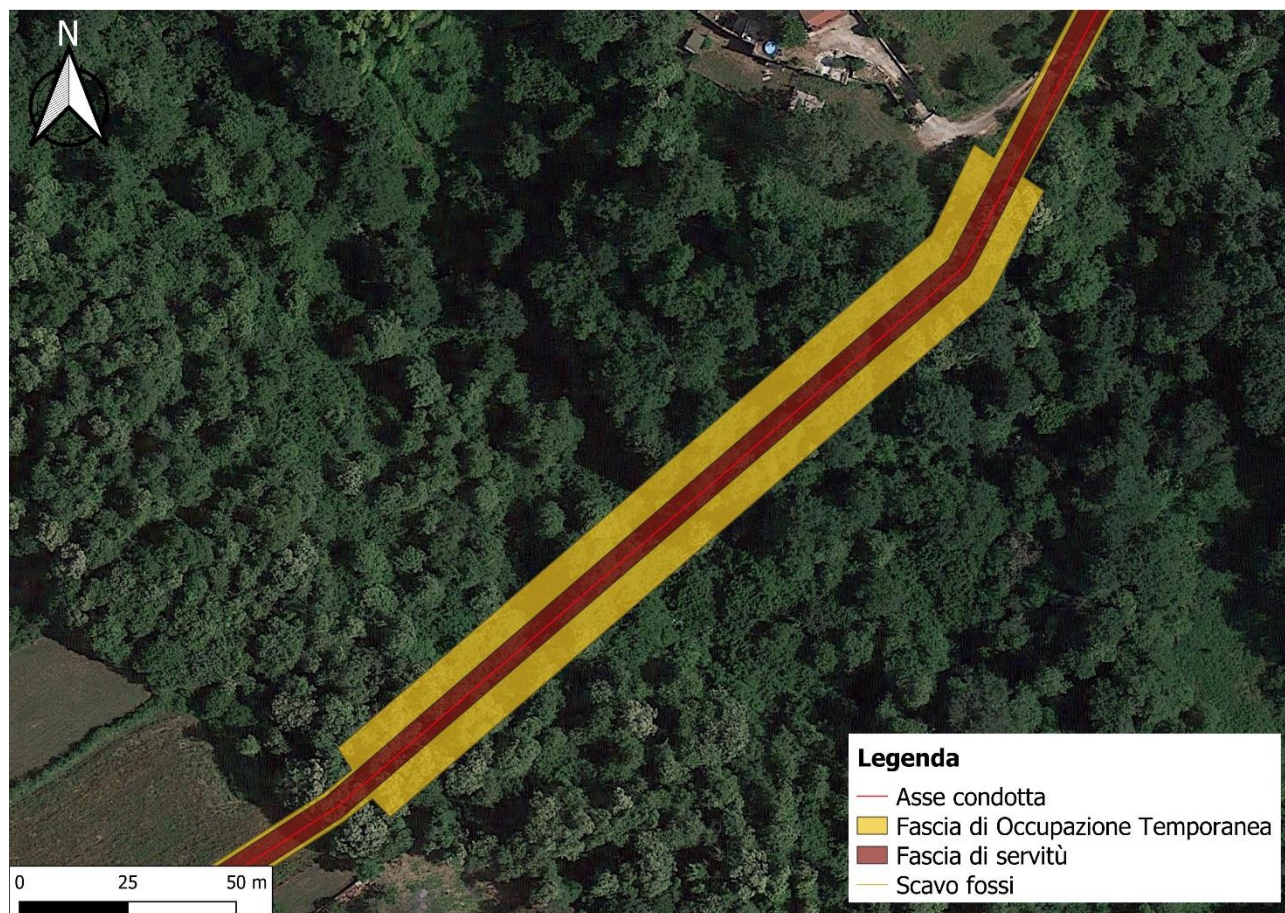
Planimetria attività di lavoro su Fosso Savo
